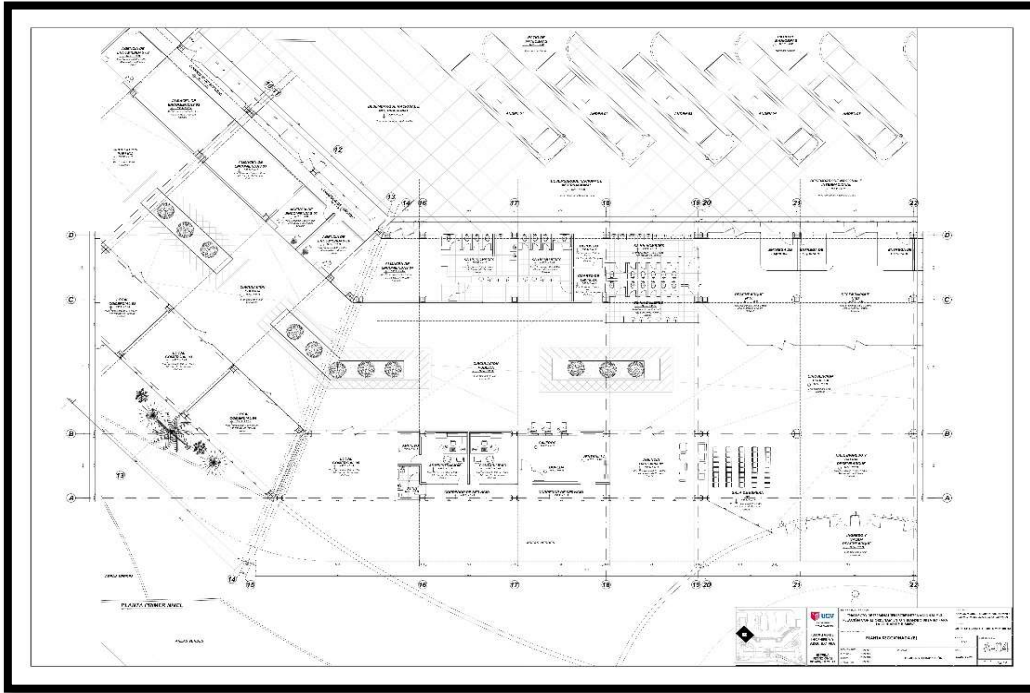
Plano Planta sector (B) Primer Nivel Fuente: *Elaboración Propia.
